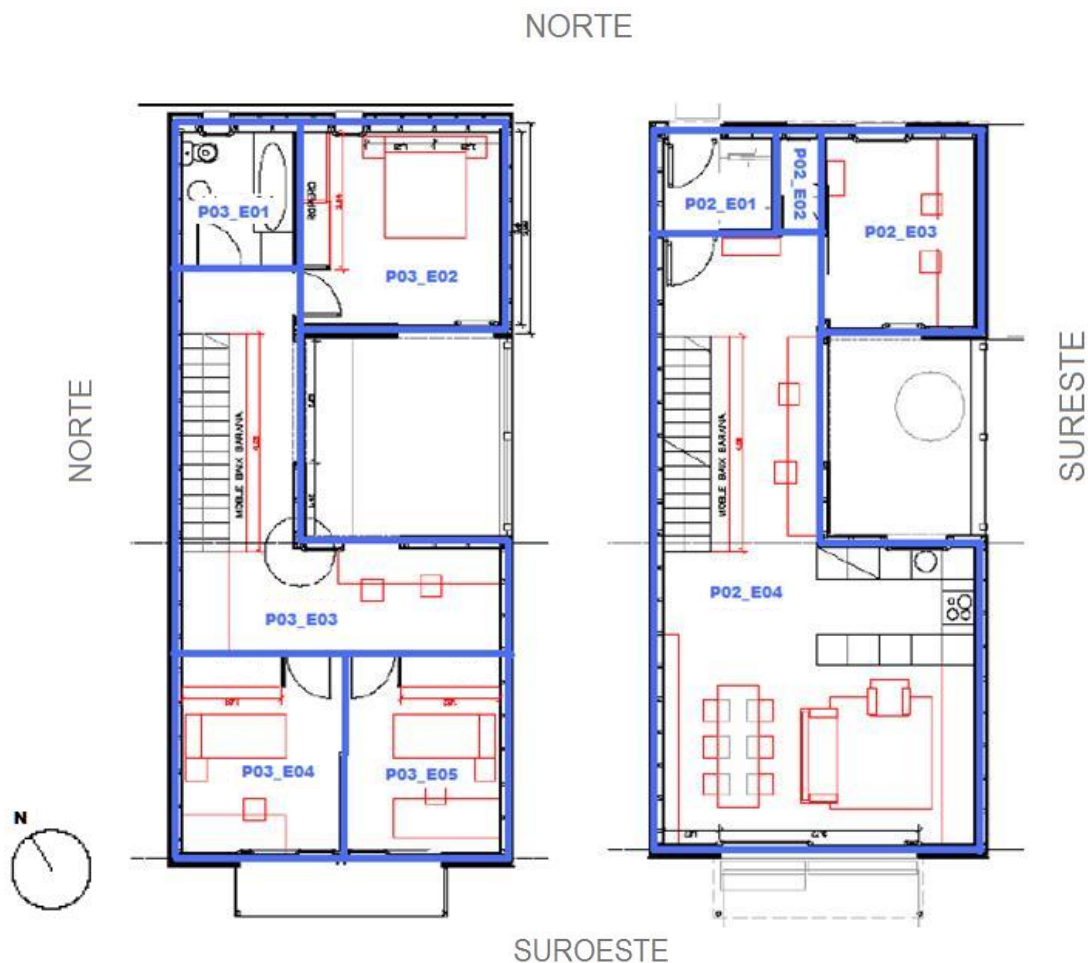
Planta primera (izquierda) y planta baja (derecha). Vivienda unifamiliar de Lleida.
